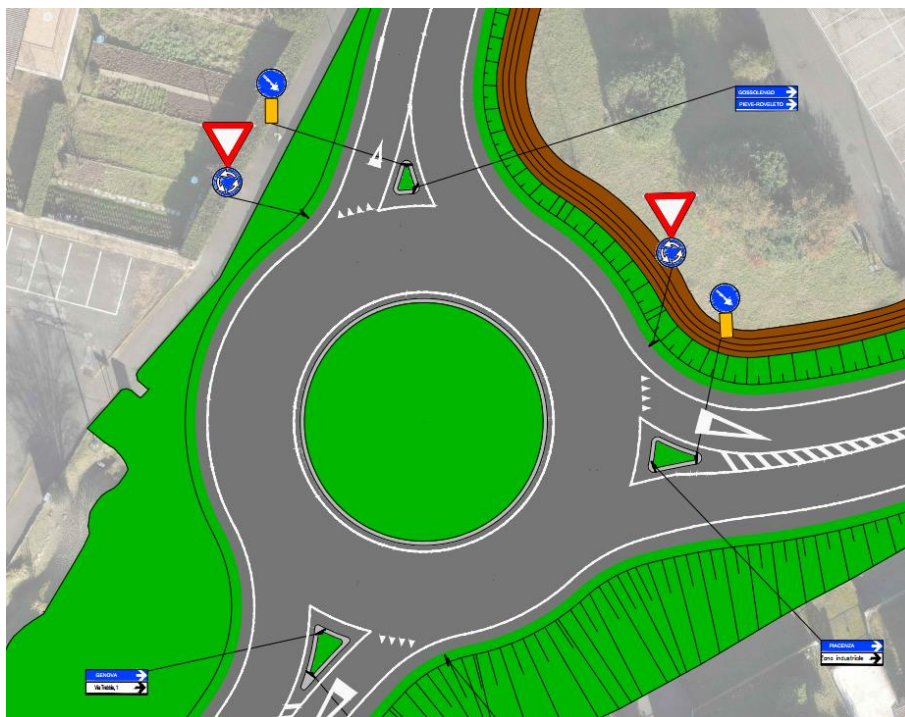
Planimetria con segnaletica dell'intersezione a rotatoria - Asse R.
